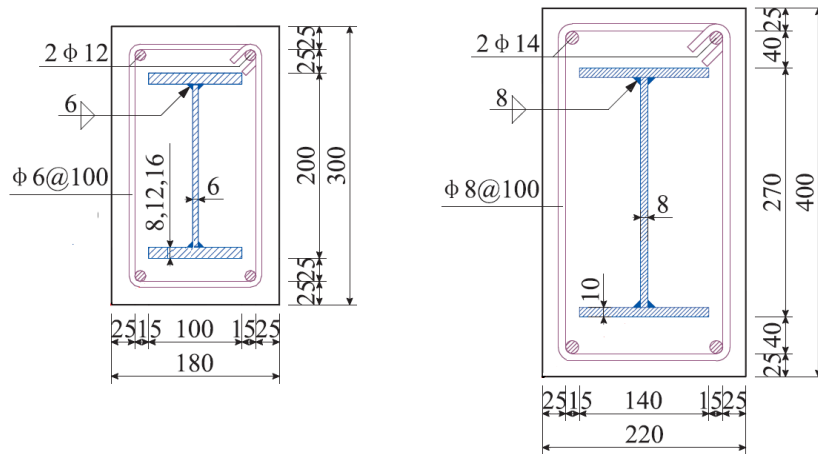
Seções transversais das vigas de TONG *et al.* (2018), em mm.
